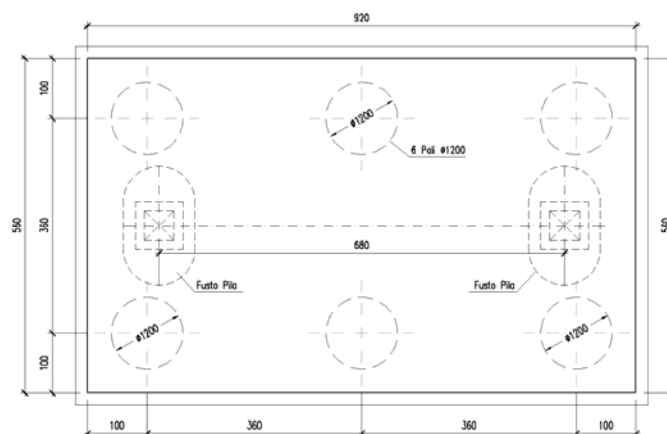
Carpenteria fondazioni delle pile 2
